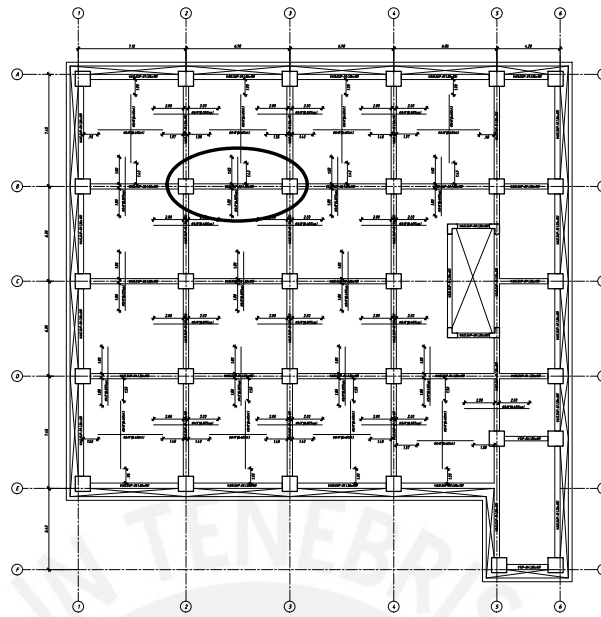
Viga de aislamiento *VAIS.SUP-02* en planta
